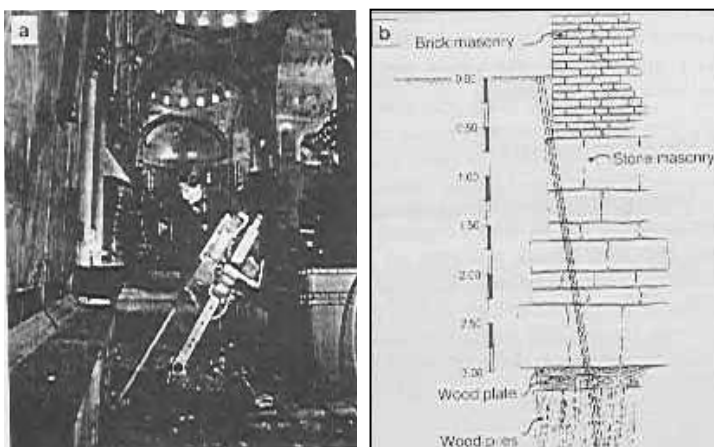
Perforación y sección obtenida en un muro de fachada de la catedral de San Marcos, Venecia. (P. Rossi)
